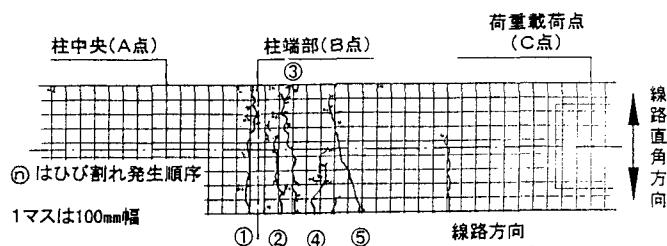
活荷重相当断面力時の床版のひび割れ状況
